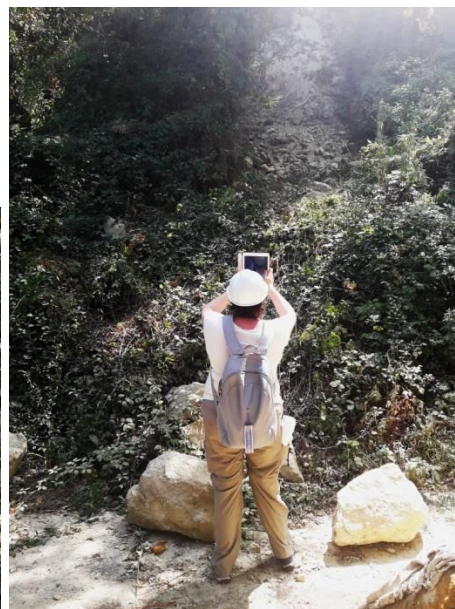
Crollo del muretto a secco lungo una traversa di via S. Barbara, Casamicciola.
